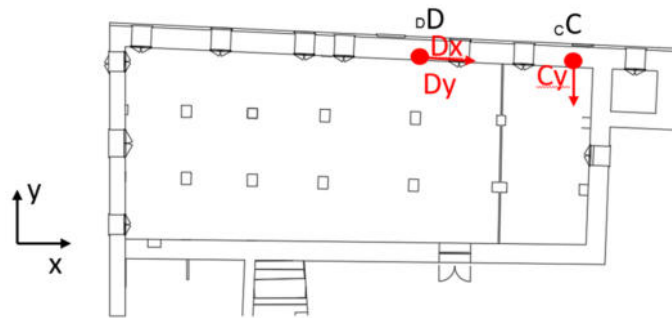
Disposizione accelerometri nel piano terra dell'edificio.
